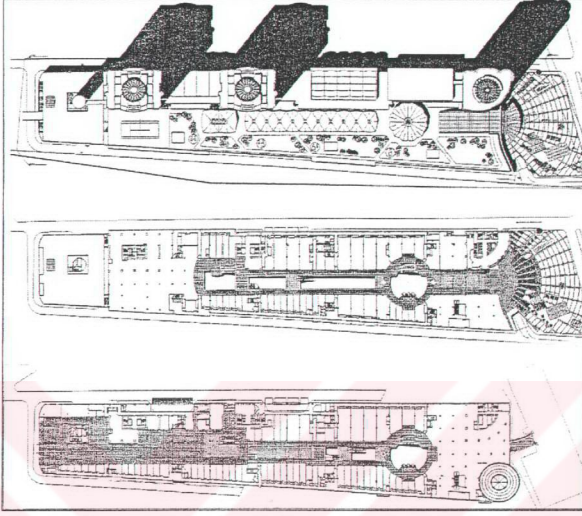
Metrocity Binası kamusal alan kullanım şeması 2.bodrum kat planı (Arredemento Mimarlık Dekorasyon)
